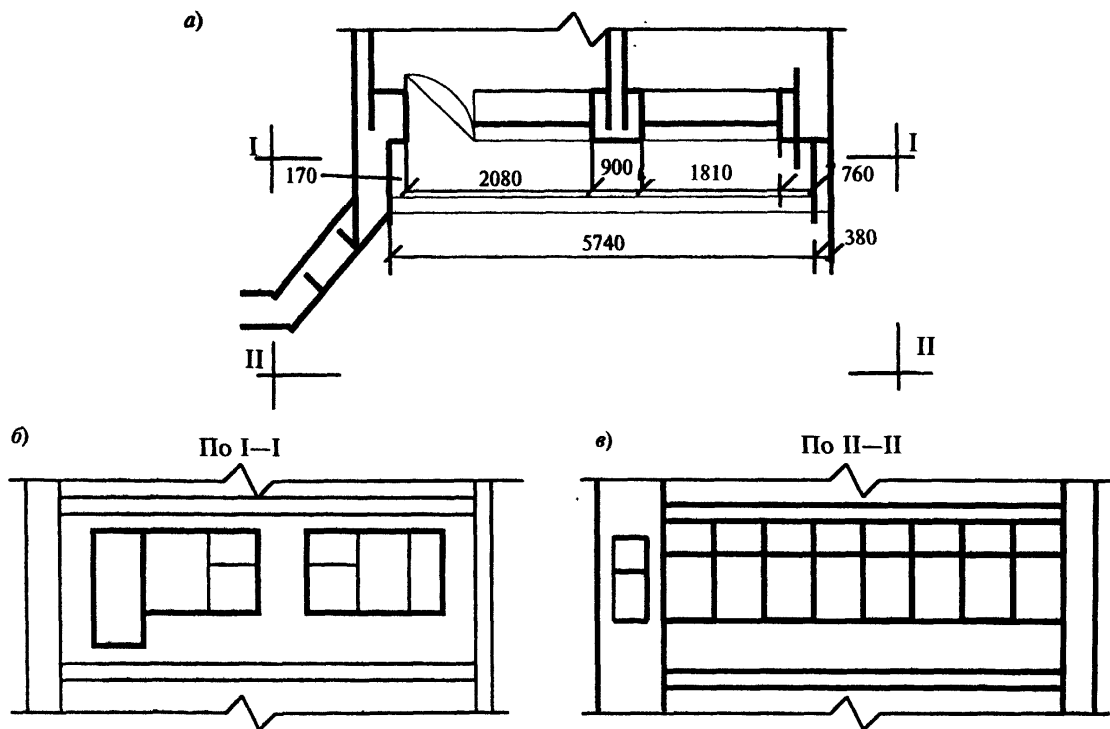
План (а), разрез (б) по сечению I-I и фасад (в) по сечению II-II плана остекленного балкона многоэтажного жилого здания
